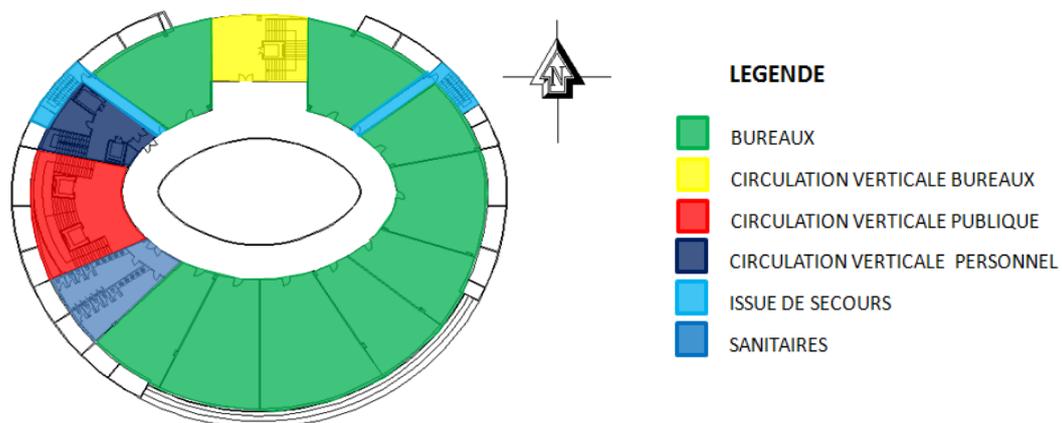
Plan traité du 5ème étage au niveau +22.44.
